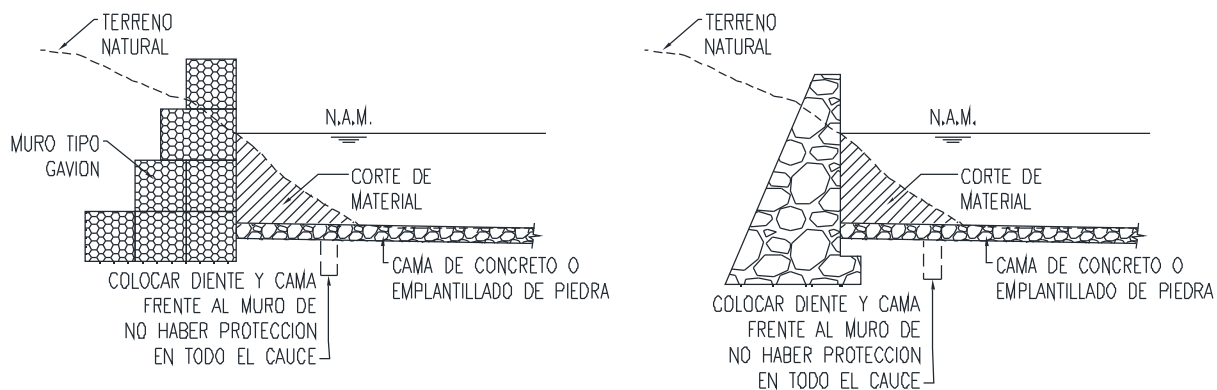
Tipos de protecciones para muros de márgenes con losa de protección. (SPOP, 2014)
